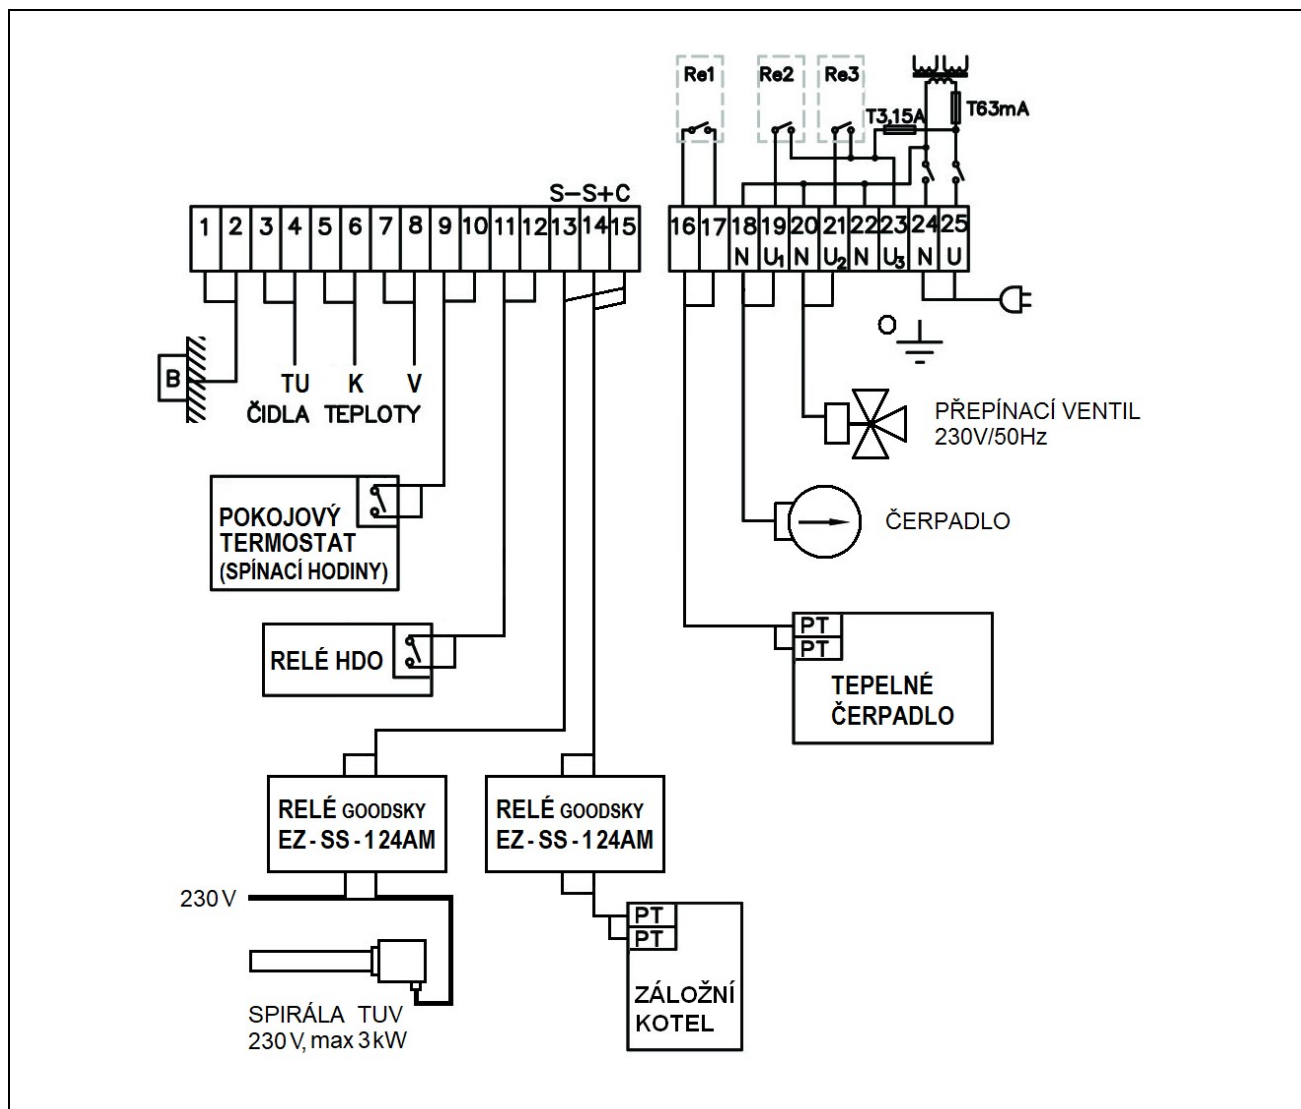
Funkční schéma zapojení s bojlerem typu OKC – „Systém 2“
